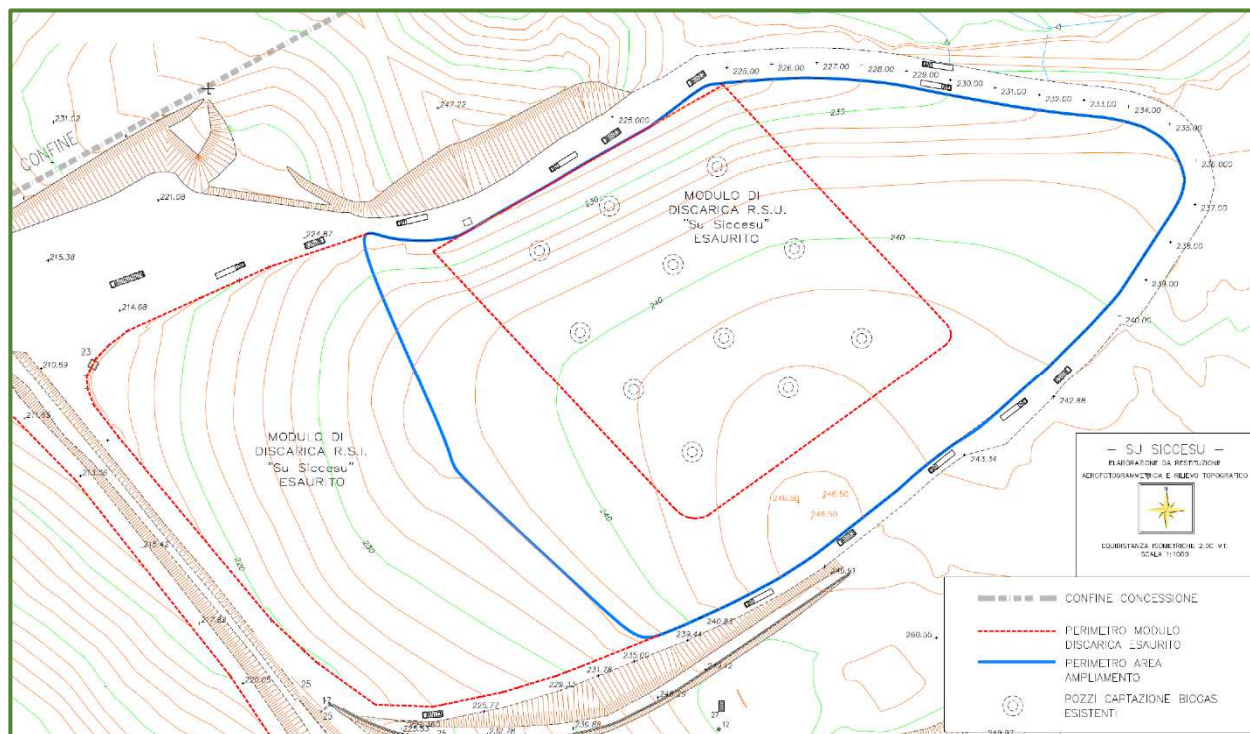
/II: Planimetria modulo n. 6 (perimetro in blu)
